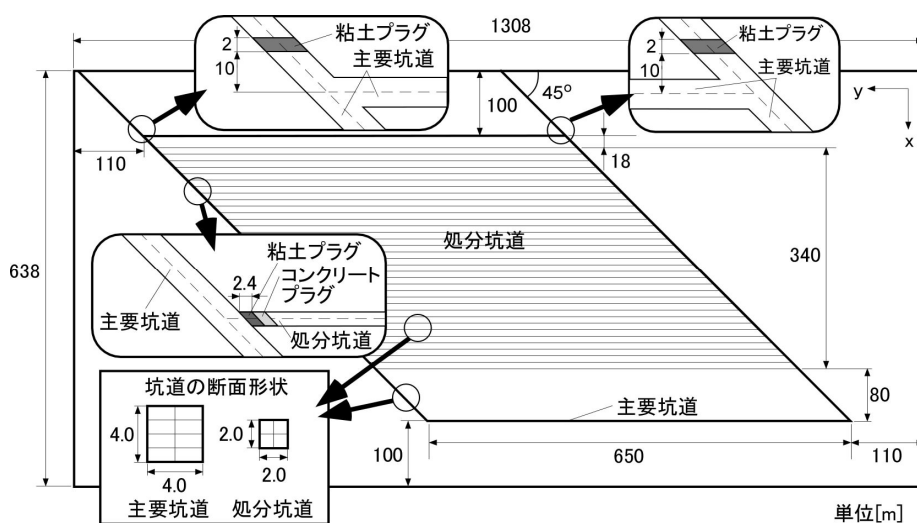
解析モデル断面図（図-3.7のAより観た図）
